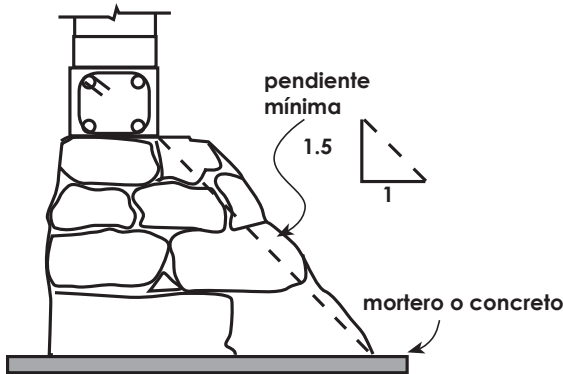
CIMIENTO DE MAMPOSTERÍA
